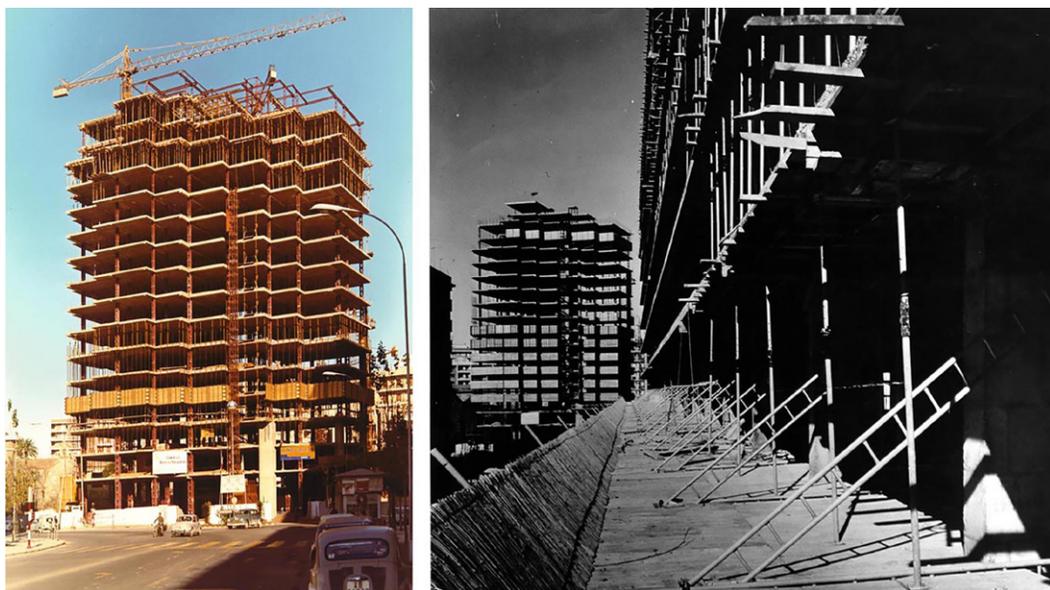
/ Escario-Vidal-Vives (EVV): Edificio 'Vitalicio' en construcción, 1971, visto a cota de calle (izquierda) y desde el edificio de Galerías Preciados, también en construcción (derecha)
